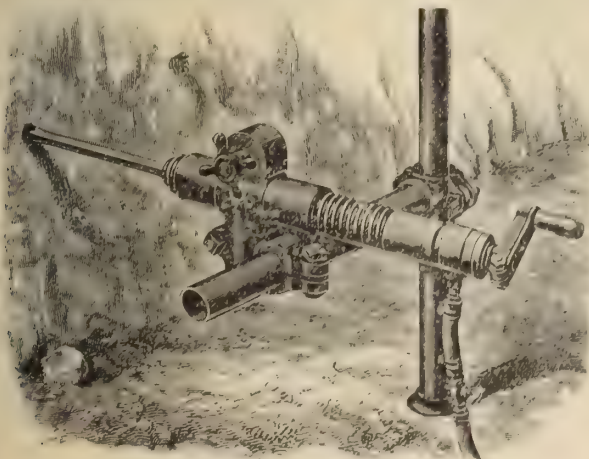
Verlagerung der Schlagbohrmaschine mit Halter, Hardsogg Wonder Drill Co., Ottumwa, Iowa.
